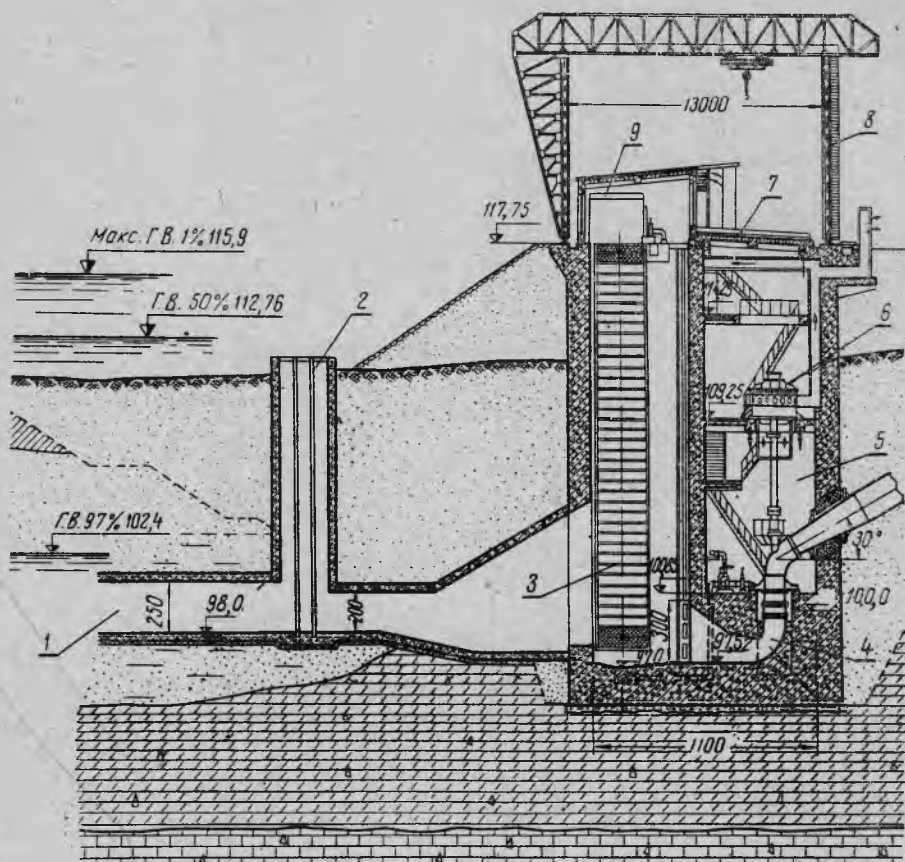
Поперечный разрез здания насосной станции шахтно-блочного типа с надземной частью только над водоприемным сооружением:
